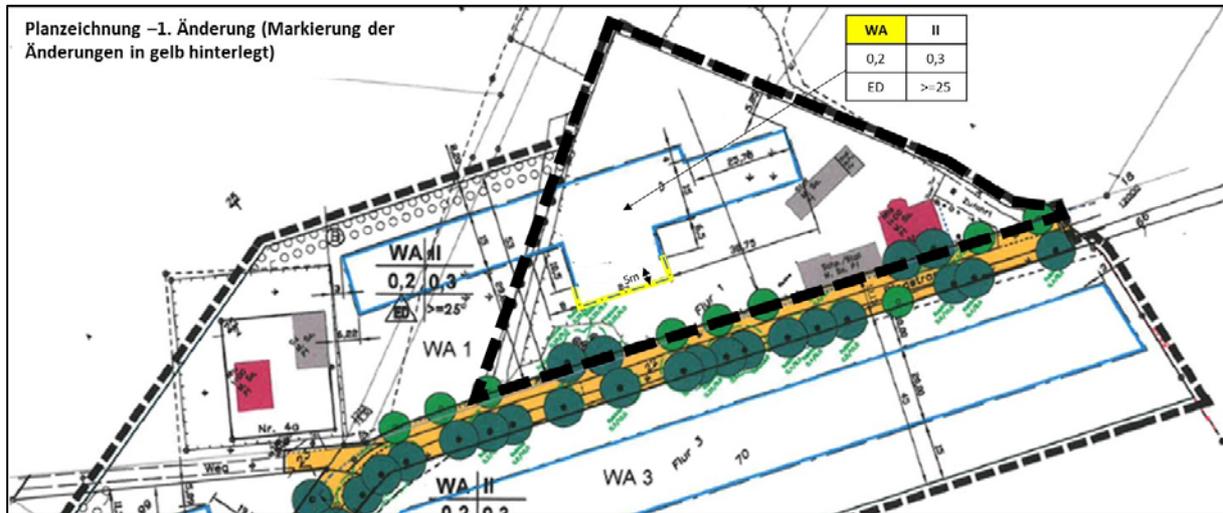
Planzeichnung – mit Darstellung der Änderungen
